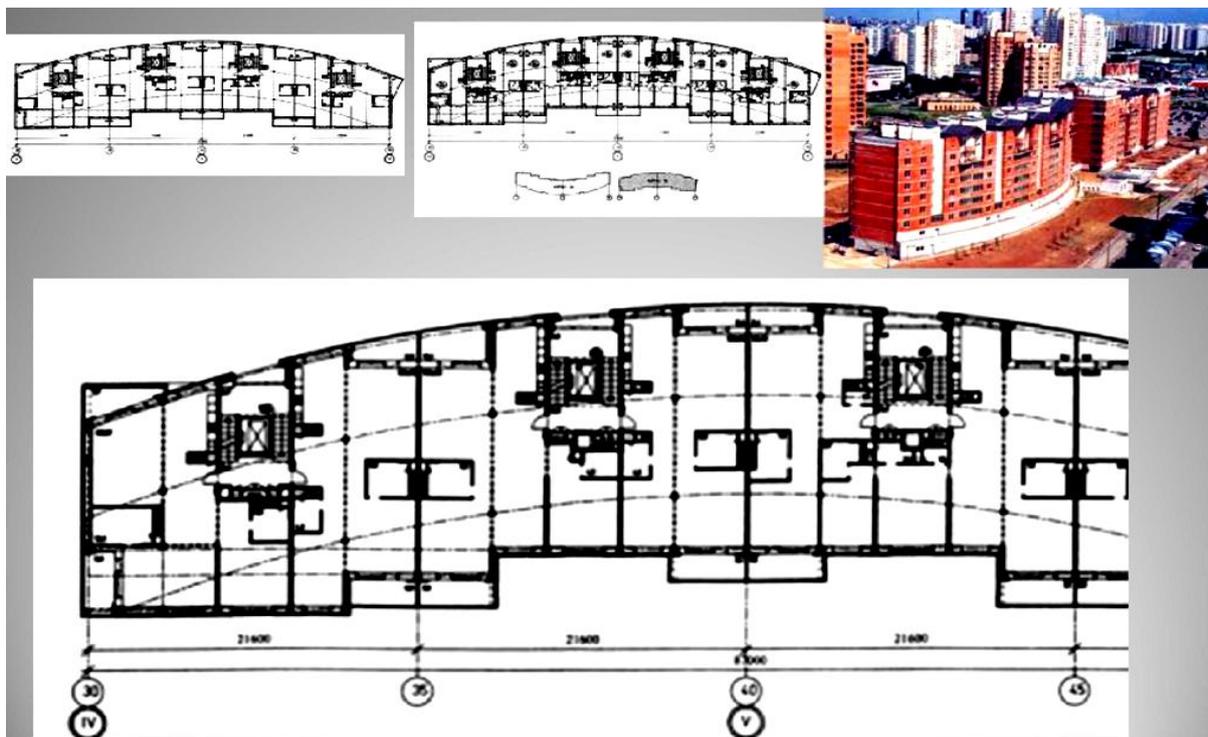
План 4-секционного жилого дома со смешанной конструктивной схемой каркасно-стеновой с колоннами круглого и прямоугольного сечения и железобетонными стенами
